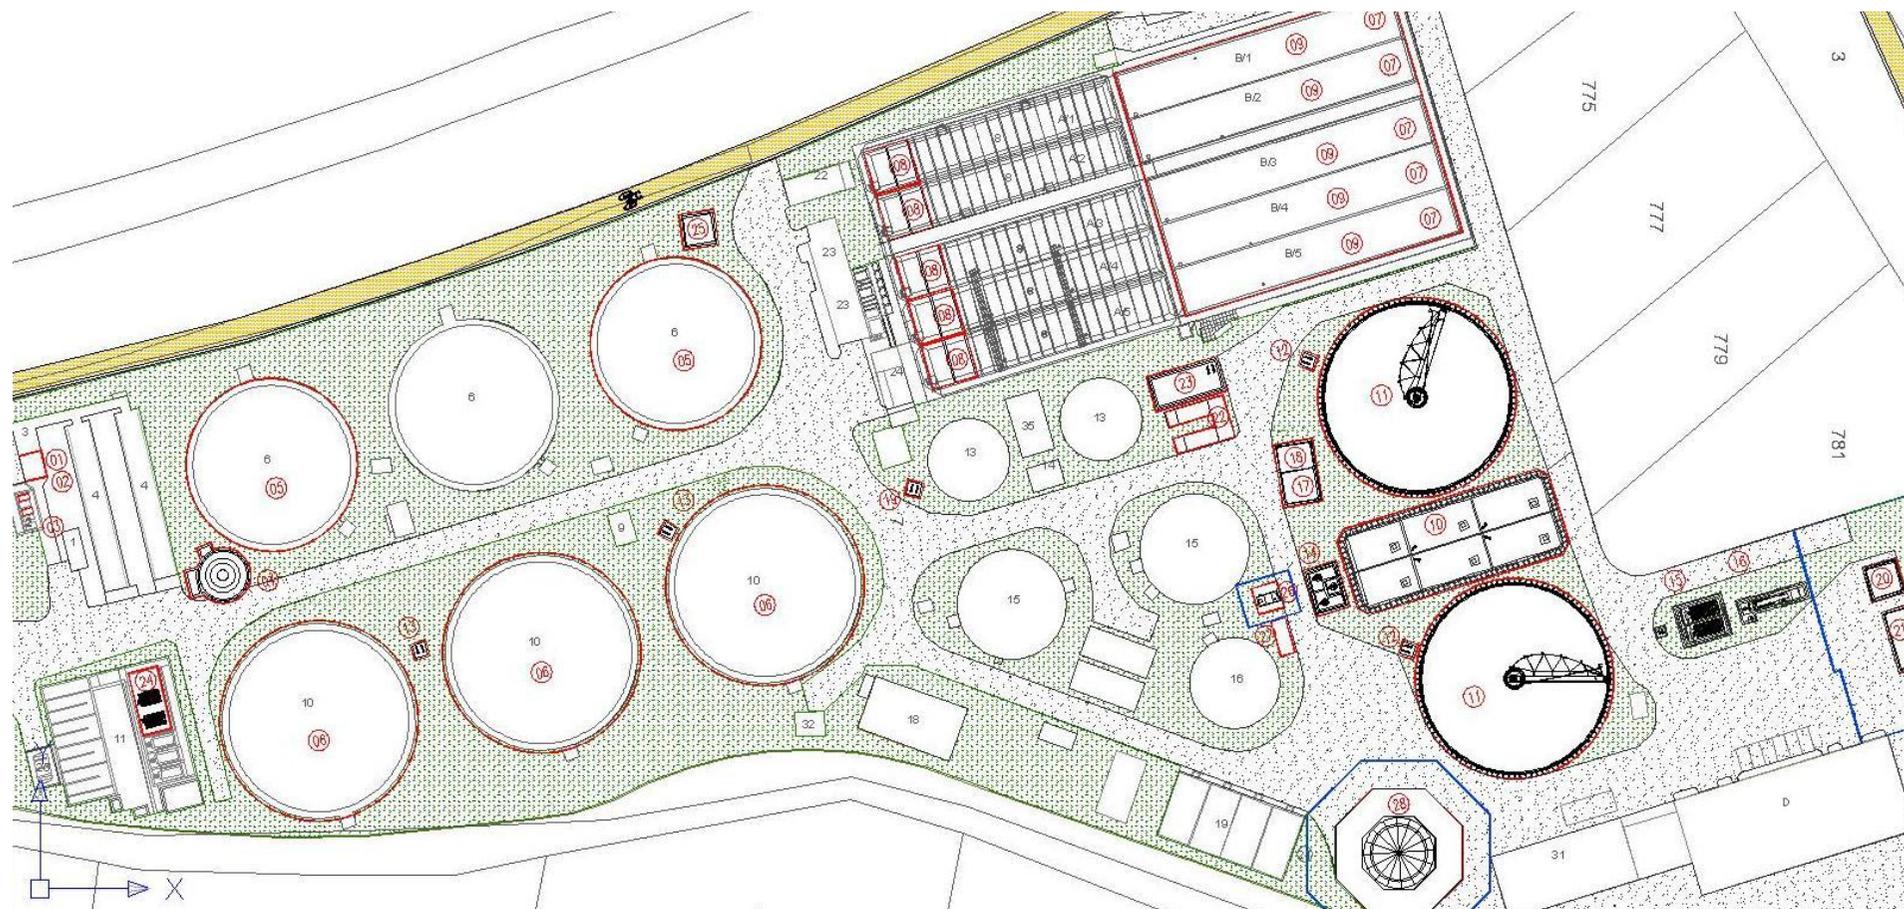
Planimetria dell'impianto con individuazione degli interventi in progetto
